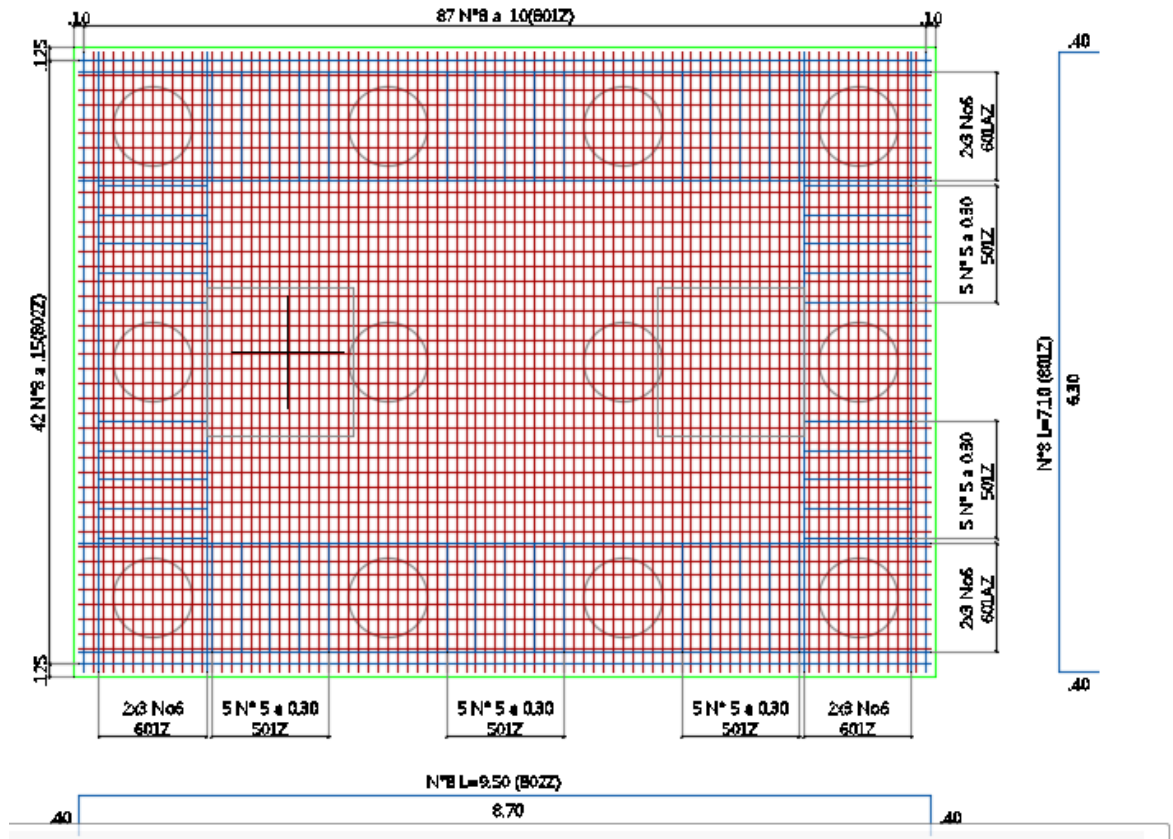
Detalle refuerzo superior zapata sobre el eje 4. (Dis Diseñadores)
